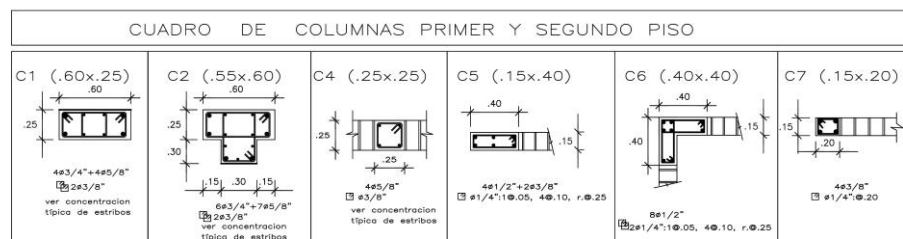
Cuadro de columnas del módulo 780 reforzado.
